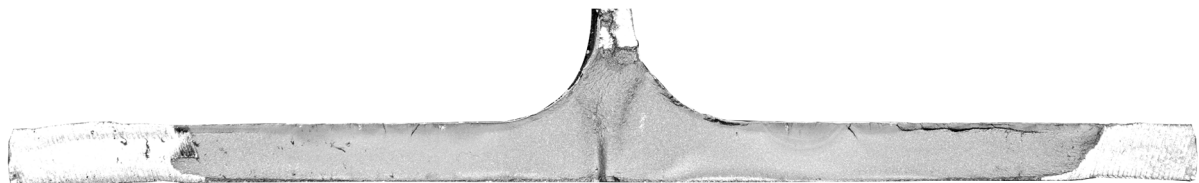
Bruchbild Versuchsträger 2.18 – Steife Nr. 5 - Detailansicht
